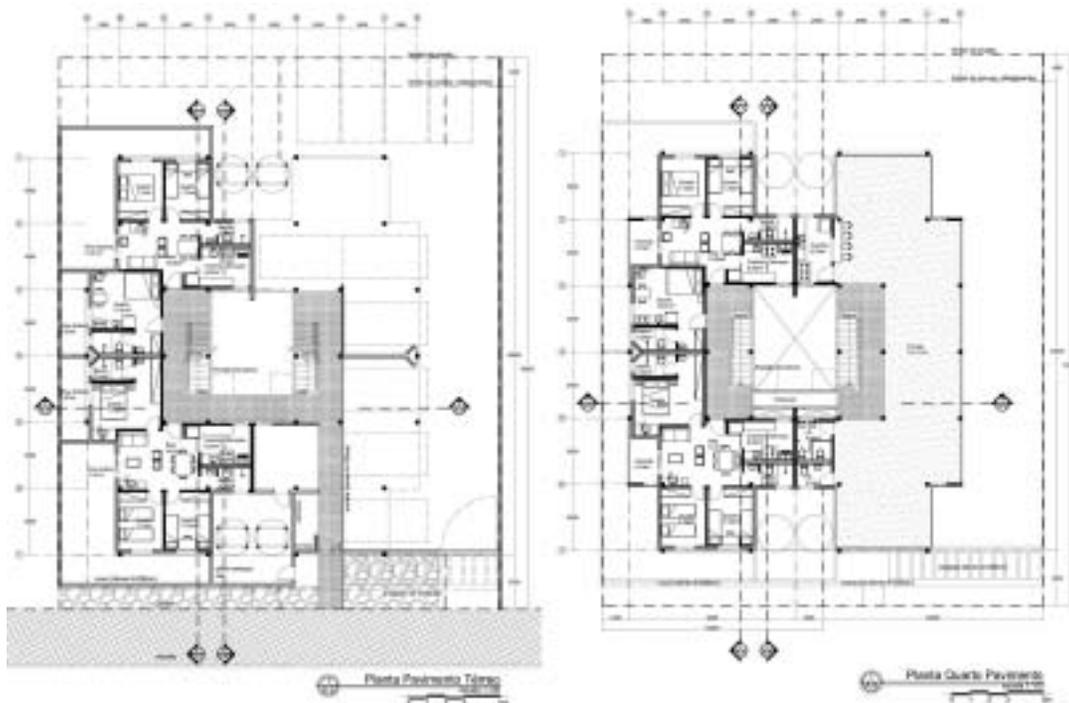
Plantas do pavimento térreo e do último pavimento (Silva, 2004)
